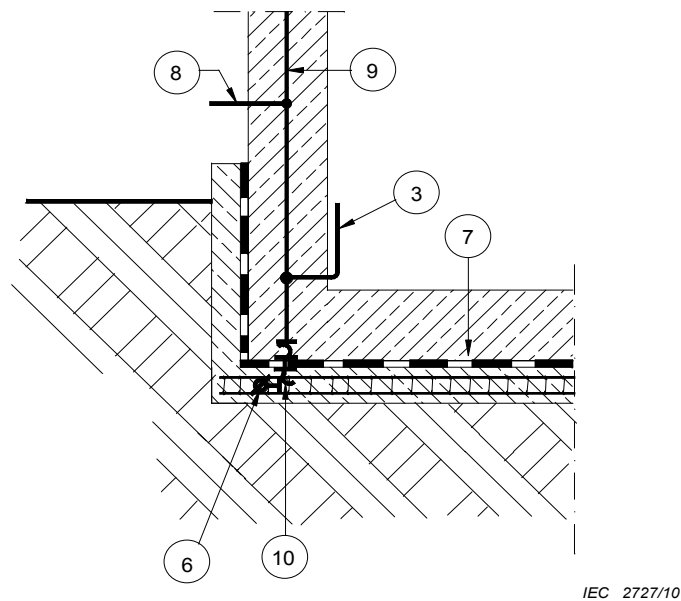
Connexion entre la prise de terre à fond de fouille et l'armature d'acier traversant la membrane d'étanchéité
